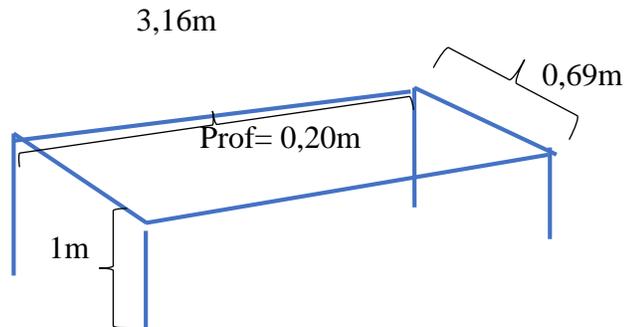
Caballetes, Soporte de las tuberías de cada parcela (batería)
